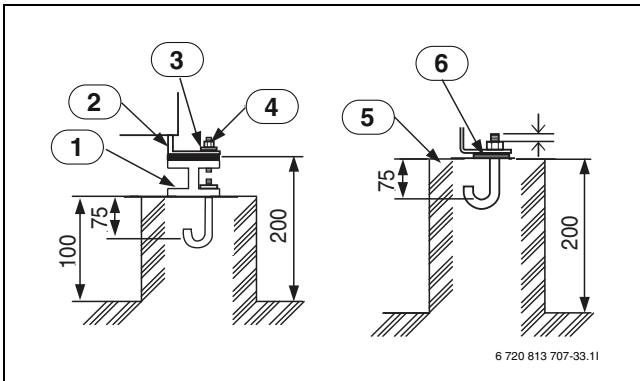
Befestigung mittels Fundamentbolzen (mm)
